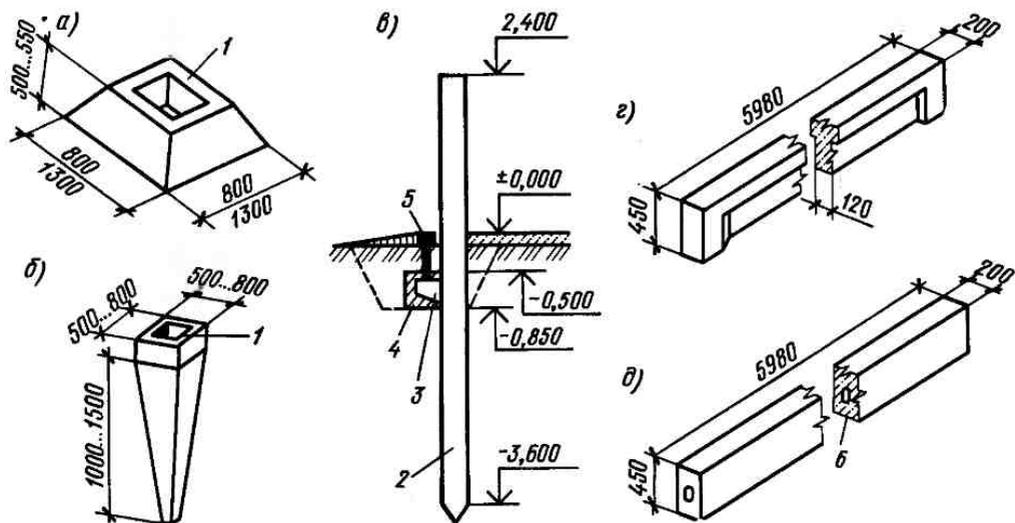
Унифицированные железобетонные конструкции подземной части сельскохозяйственных зданий:
